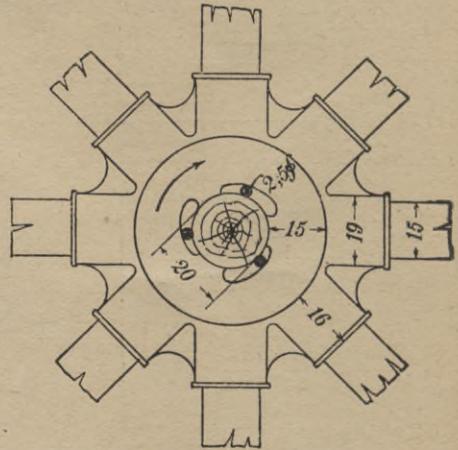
Spill zum Einschrauben von Holzpfählen. [Aus L. Brennecke „Der Grundbau“.]
